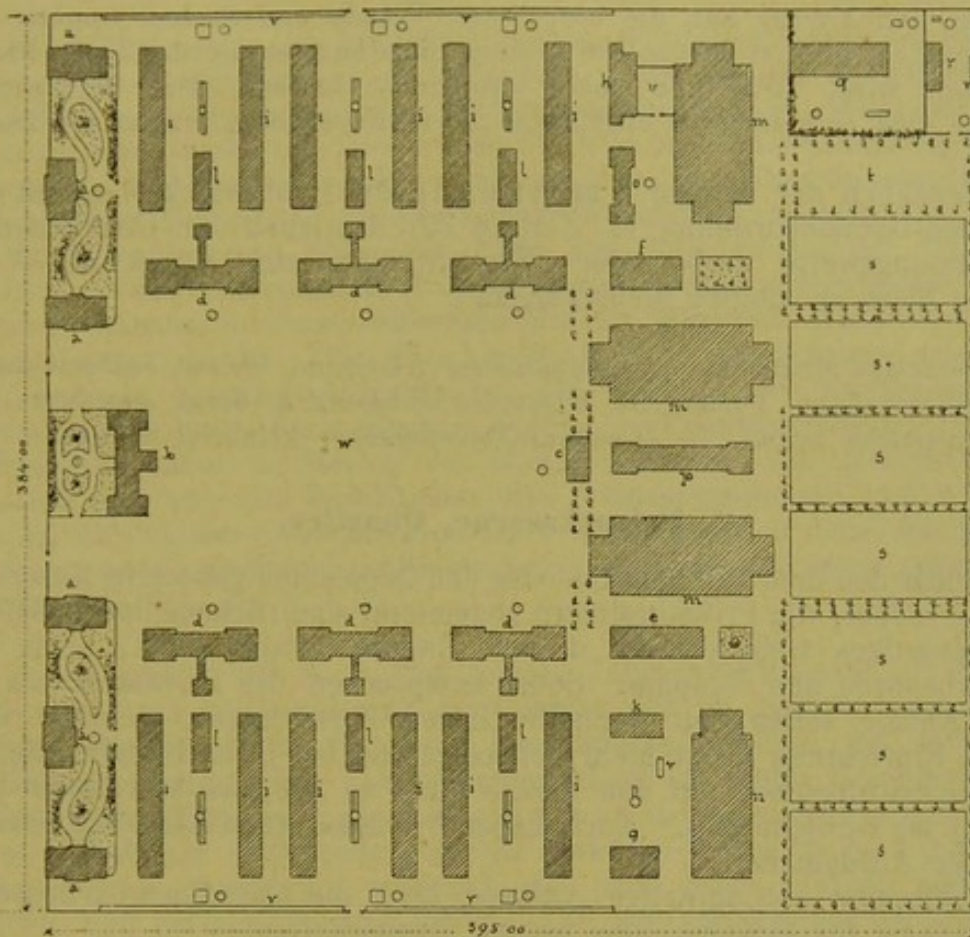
Lageplan einer Reiter-Kaserne für ein Regiment mit zweigeschossigen Mannschaftswohngebäuden im Maßstabe von 1 : 4160 nach Gruber!
